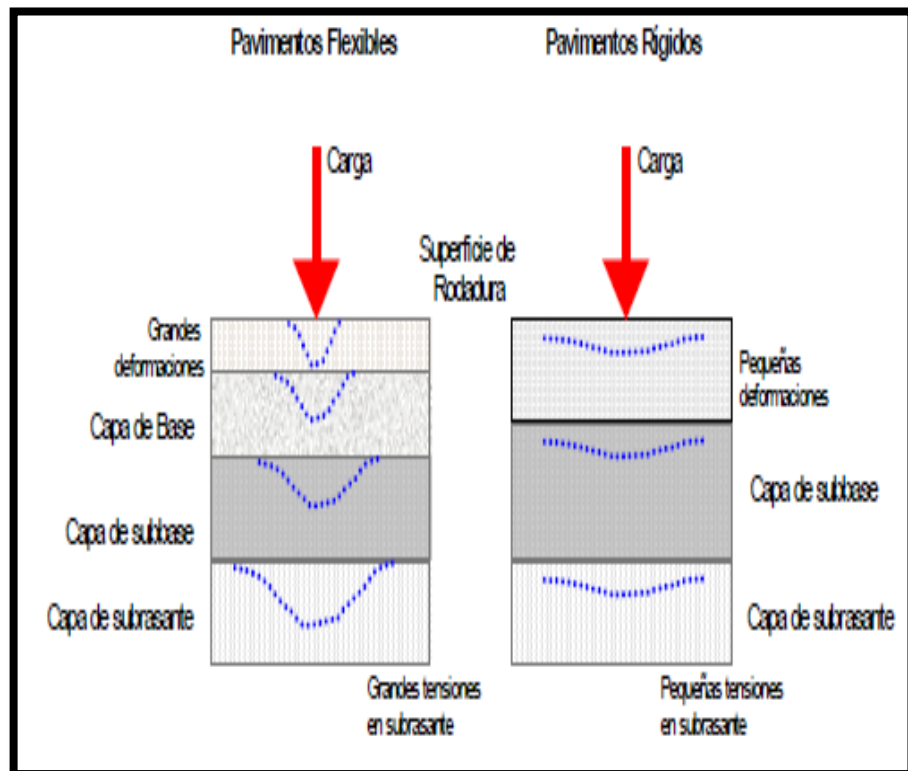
Comparación de la estructura de pavimento rígido y flexible
